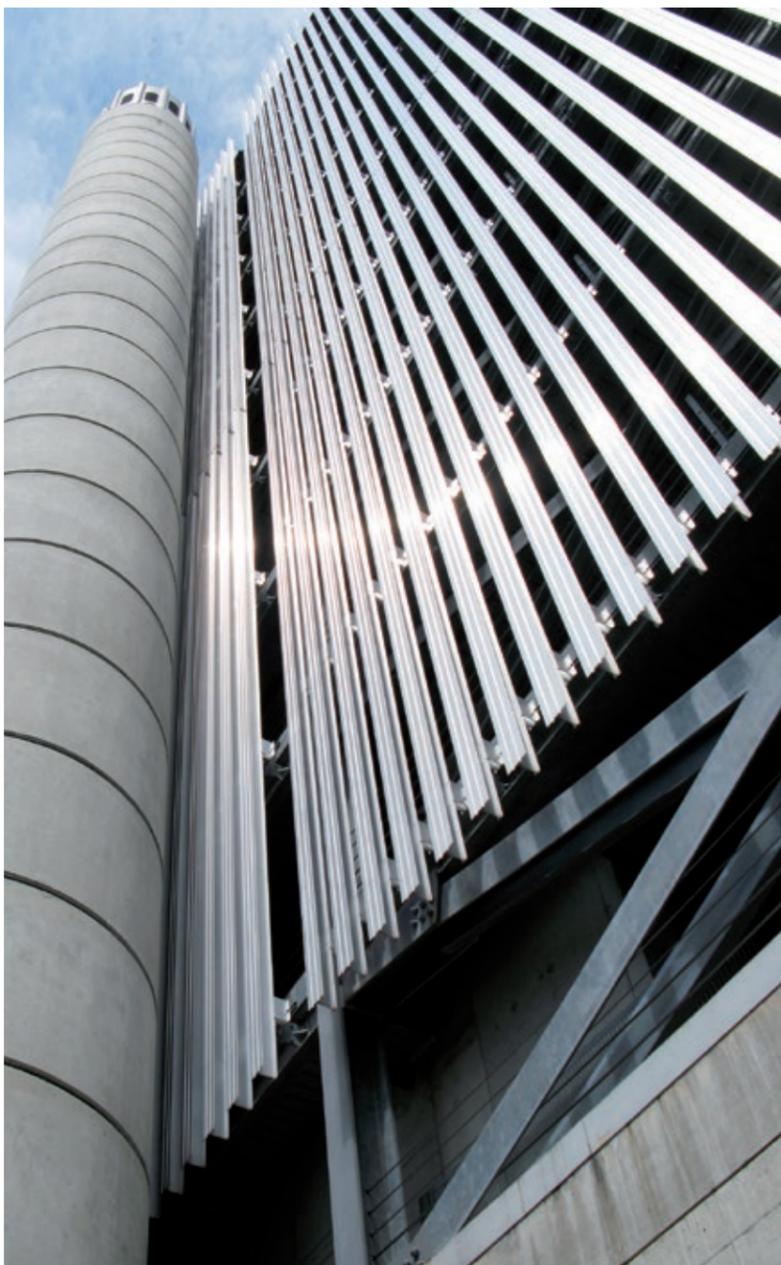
Пример решения фасада из металлических жалюзи
